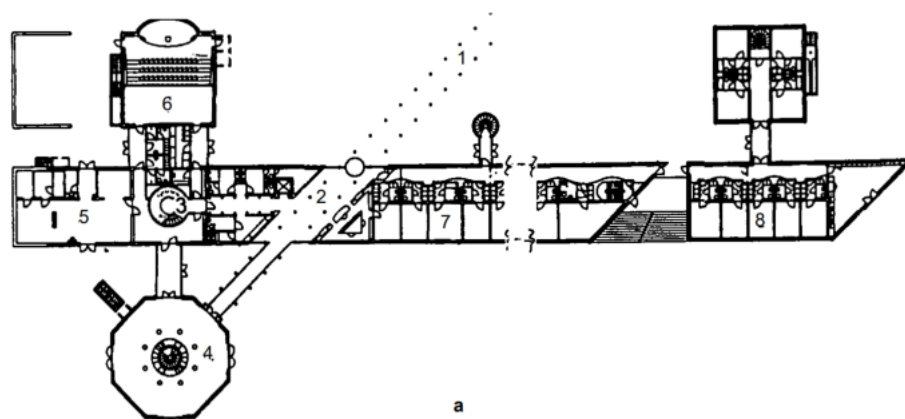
Planta do Pavimento Térreo. The Maersk McKinney Moller Centre, Reino Unido
